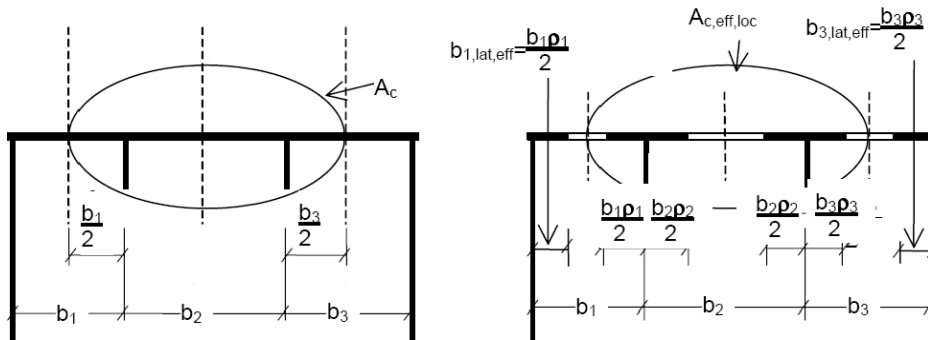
Lastra irrigidita uniformemente compressa
